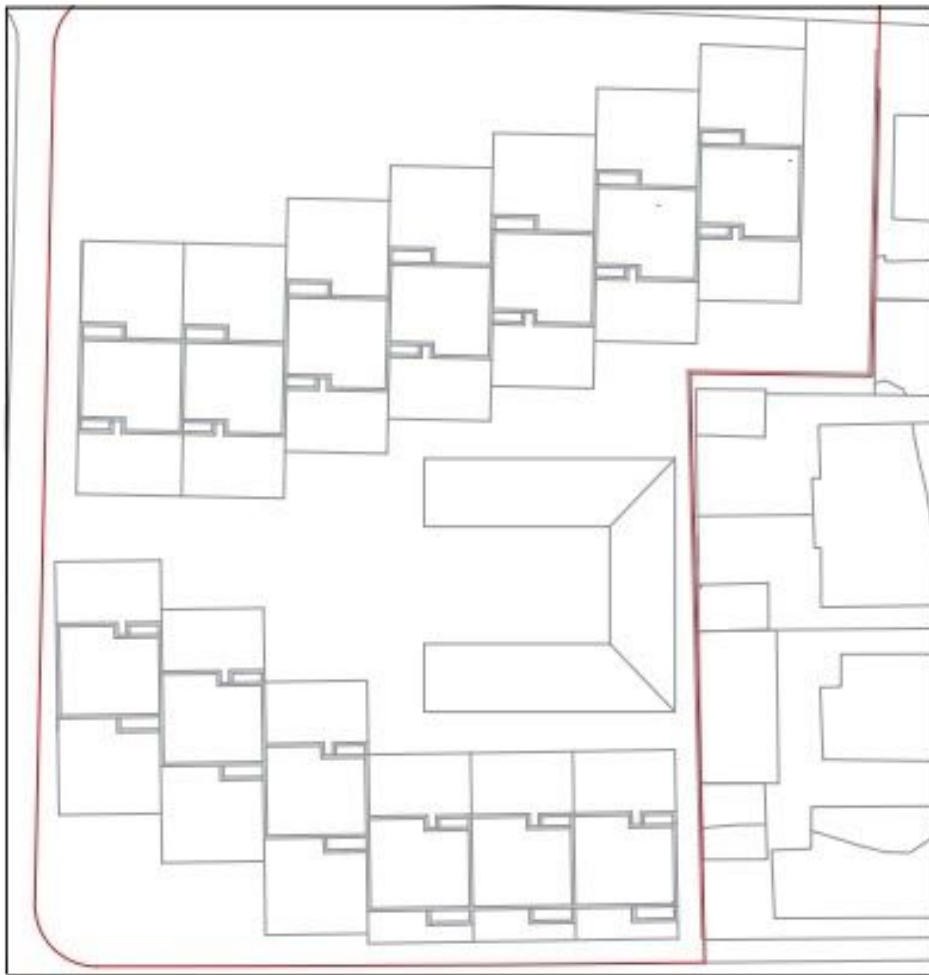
Planta de Implantação do Bairro do SAAL da Praia de Cortegaça, segundo a nova proposta.
